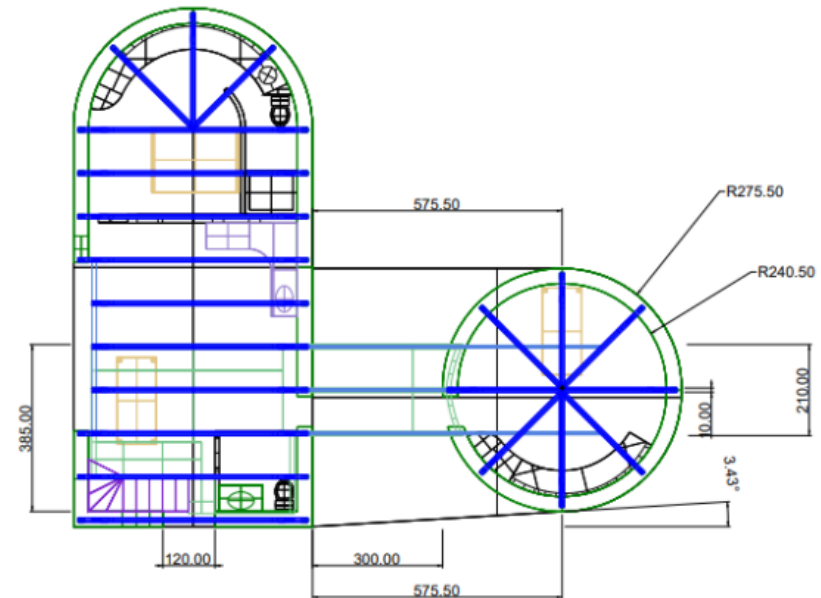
Planimetría superior del proyecto Cobijo + Pepino. Elaboración propia.
